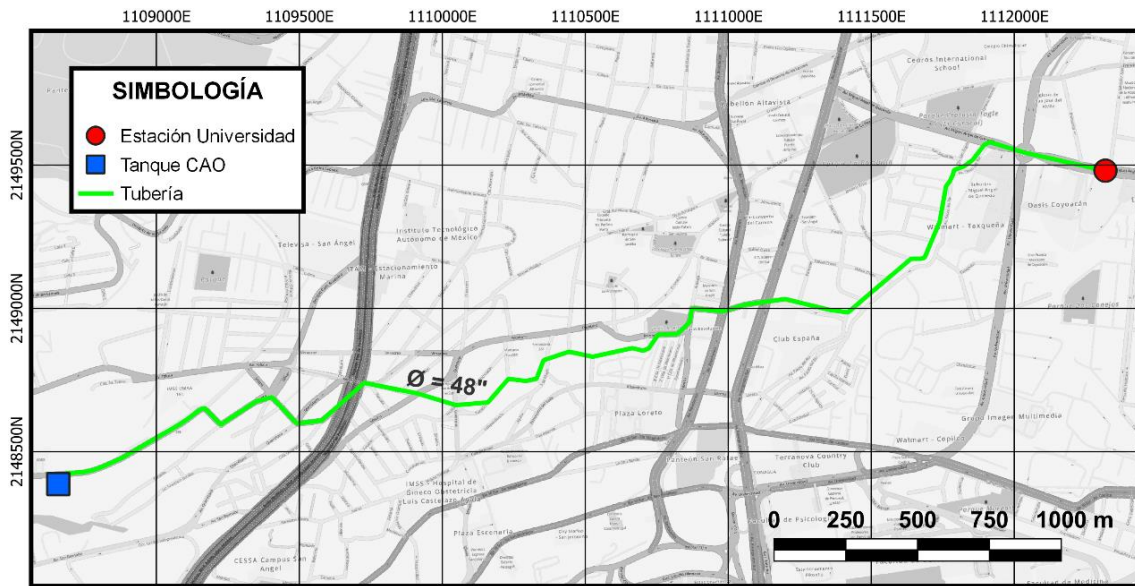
Planta de la tubería del tanque CAO a la estación Universidad
